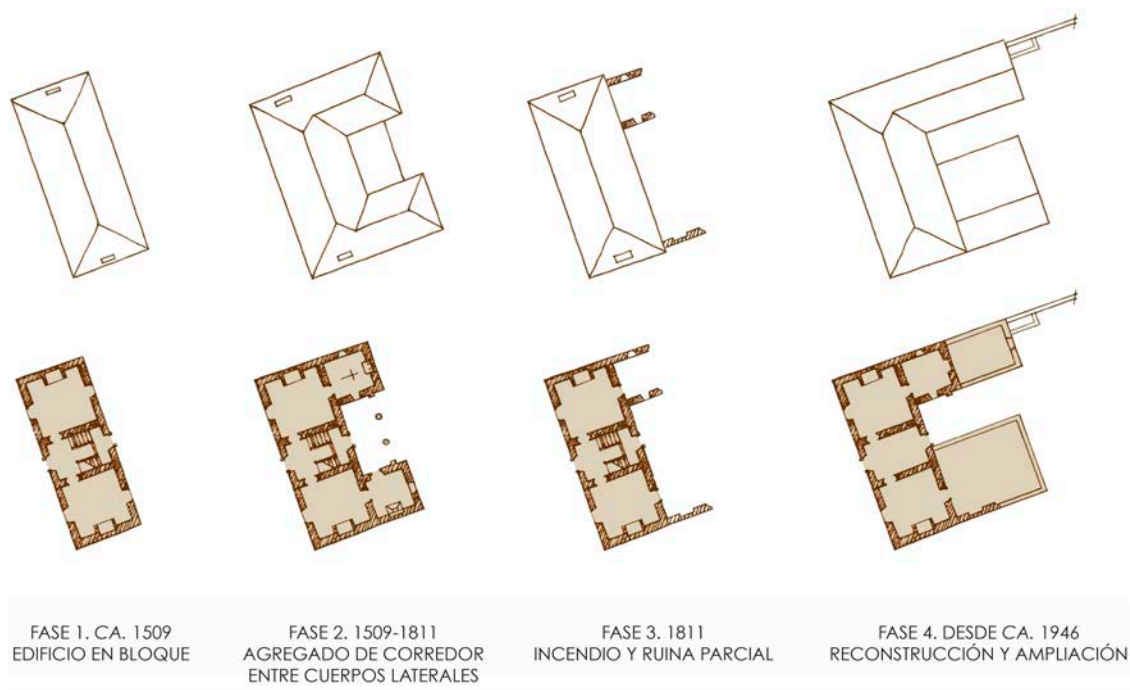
Bosque de la Chozza en Puente Ullán. Diversas hipótesis de trabajo sobre la evolución de la casa de recreo en planta de cubiertas y planta baja (elaboración propia, 2019).
